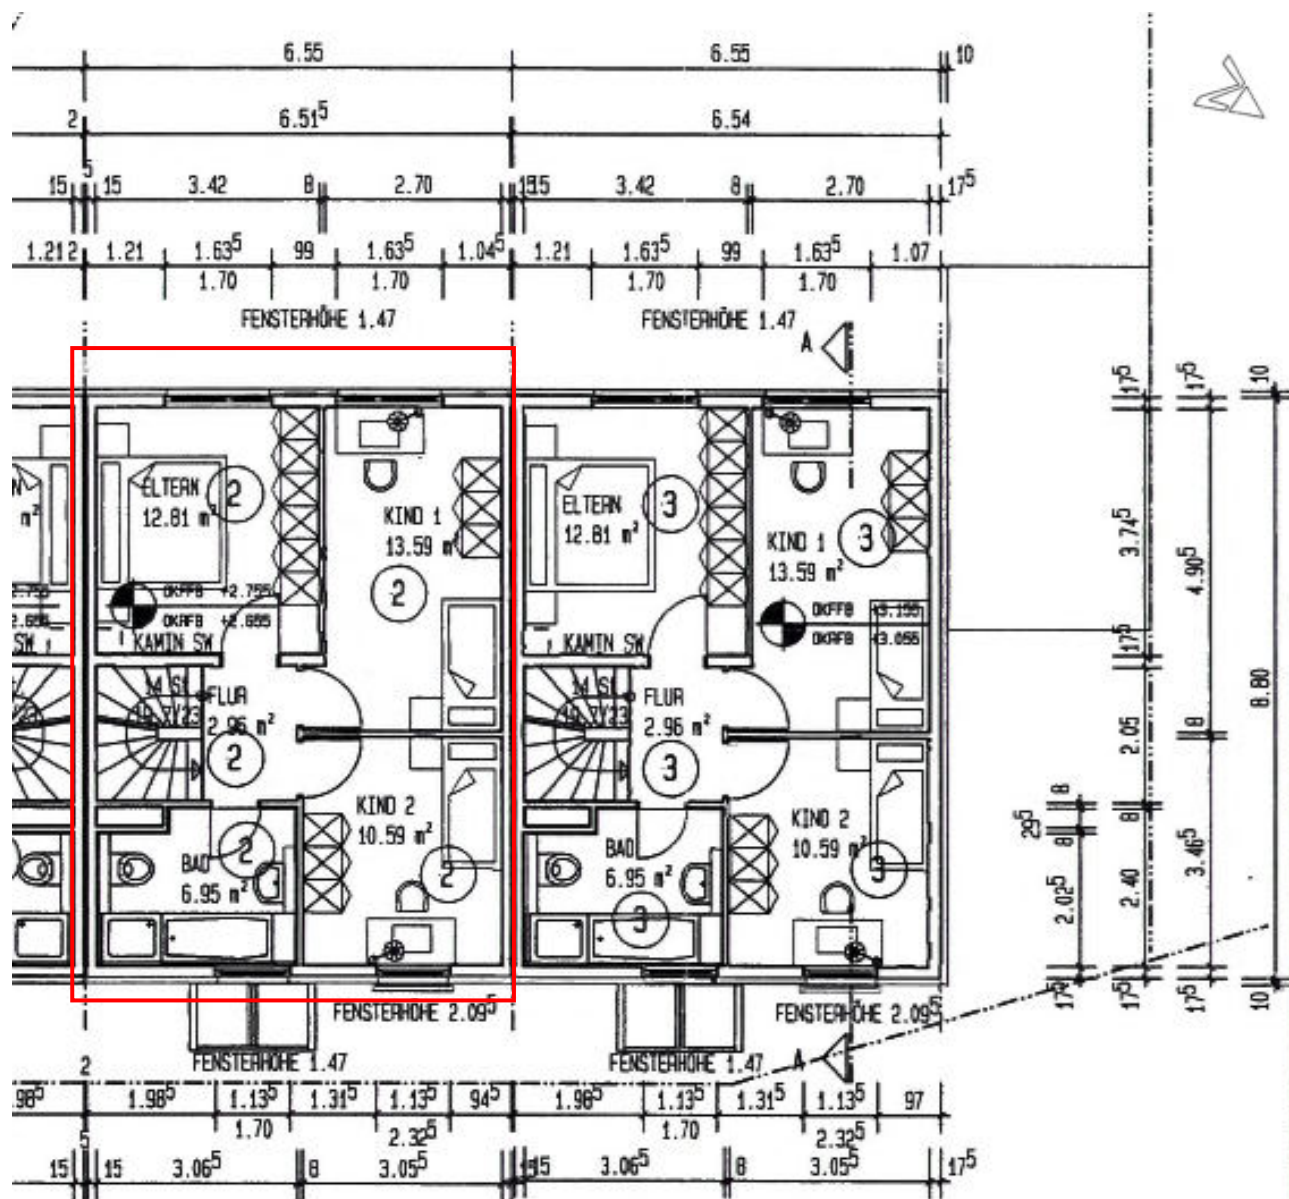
Grundriss Obergeschoss (Ausschnitt ohne Maßstab); Detail Sondereigentum Nr. 2; Quelle: Bauakte; Roteintragung durch den SV
